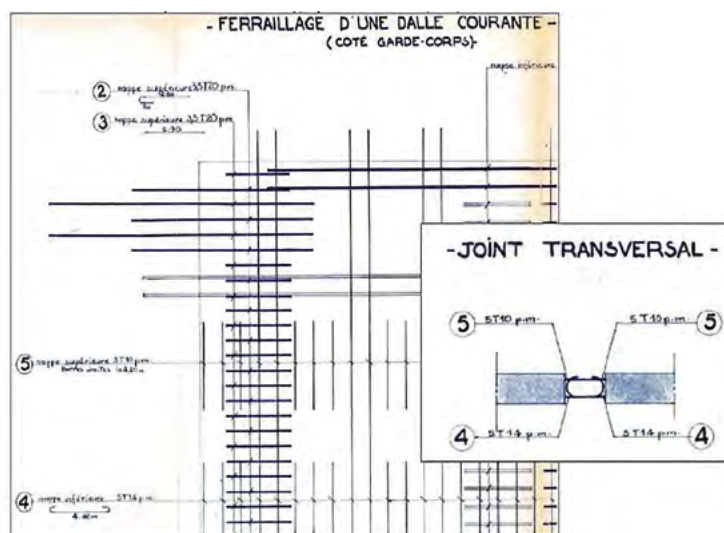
Schéma du ferrailage du clavage des dalles du pont de Frouard
